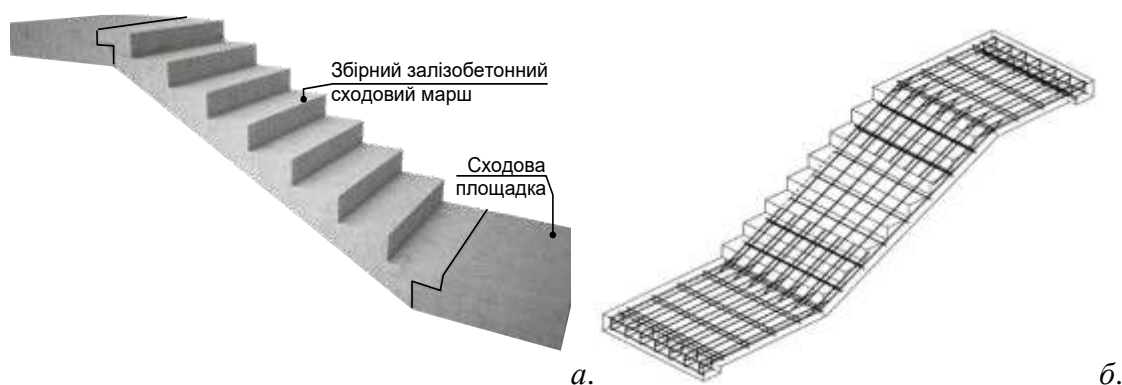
Конструкція збірного залізобетонного сходового маршу (а) та схема його армування (б).
